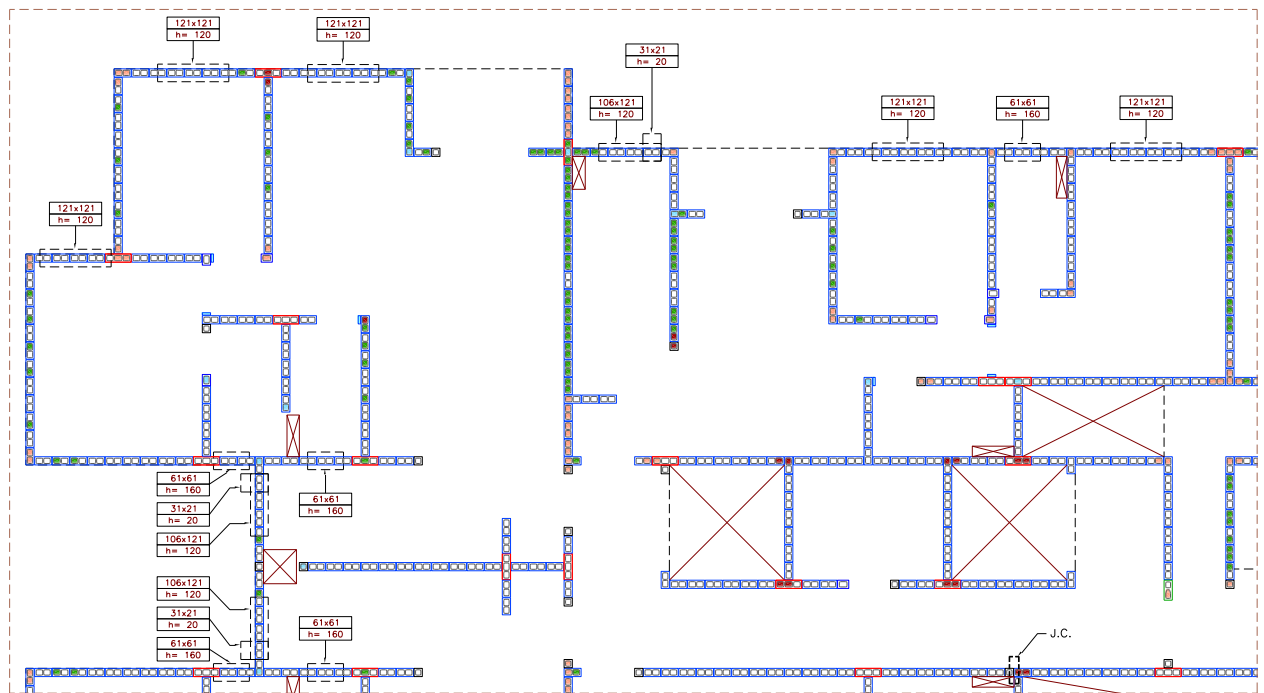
Edifício Vita Belle: detalhe da planta de modulação
